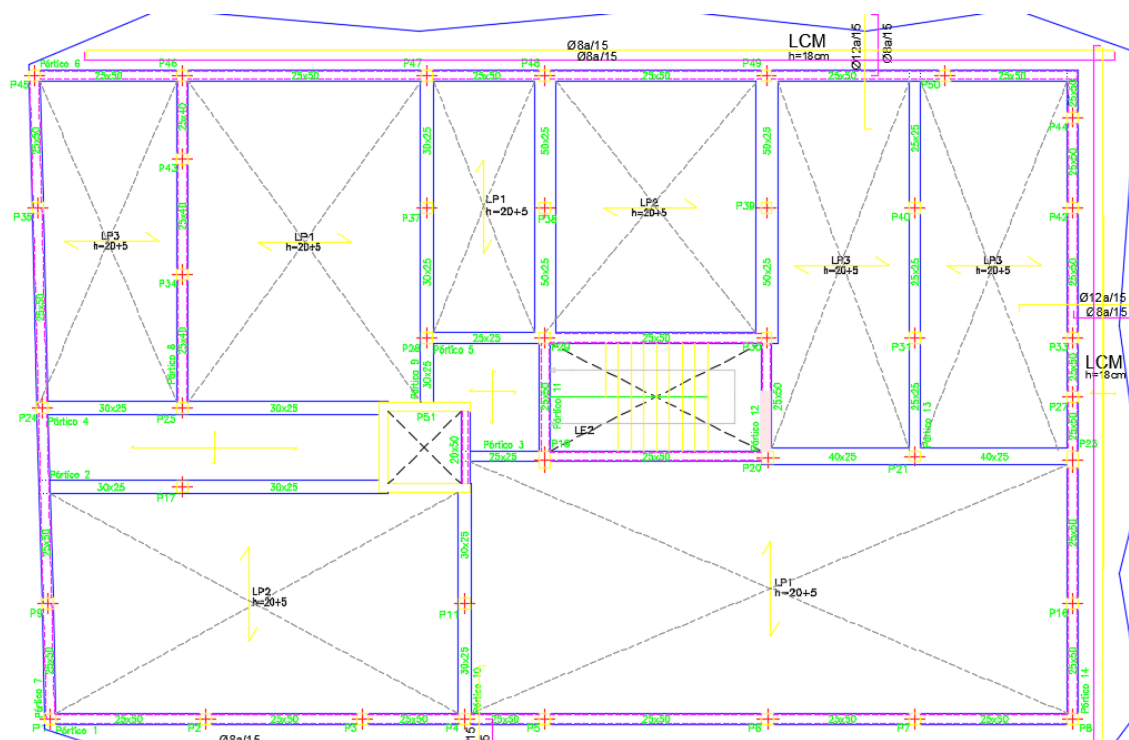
Planta estrutural do 1º andar da obra N°7 (1+1 Arquitectos, 2017).
